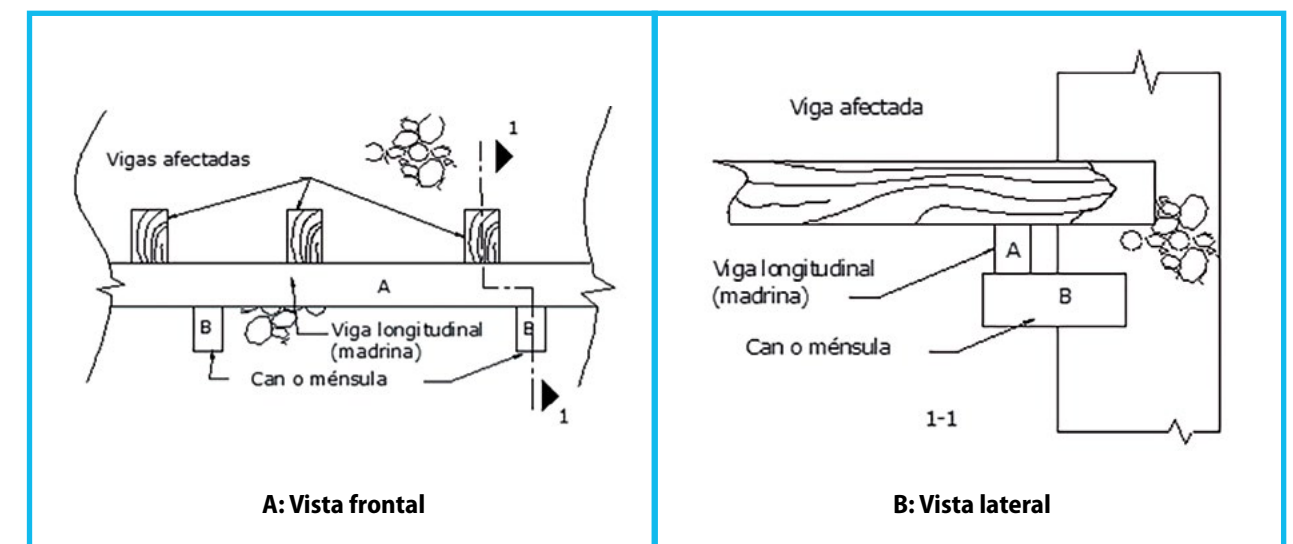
Refuerzo de los cabezales mediante viga longitudinal
